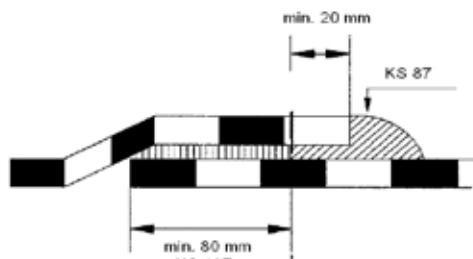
Assemblage par recouvrement au KS 137 + KS 87
